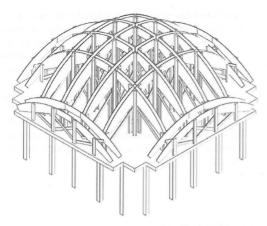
Reconstrucción de la cimbra de madera para una bóveda por cruceros. 2011
